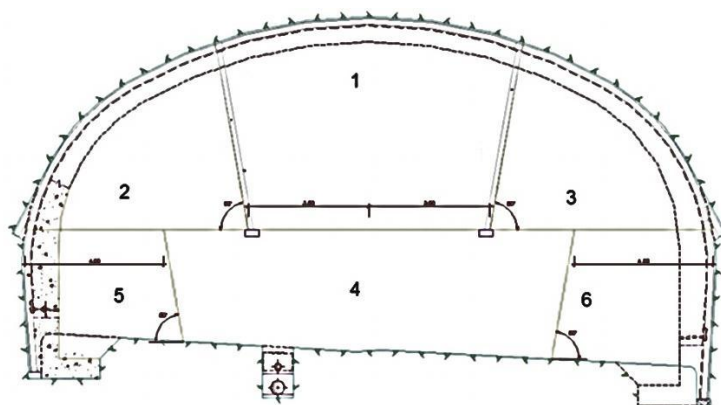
Faseamento de escavação para a zona ZG3 em secção de alargamento com aplicação de cambotas HEB200 e HEB220
